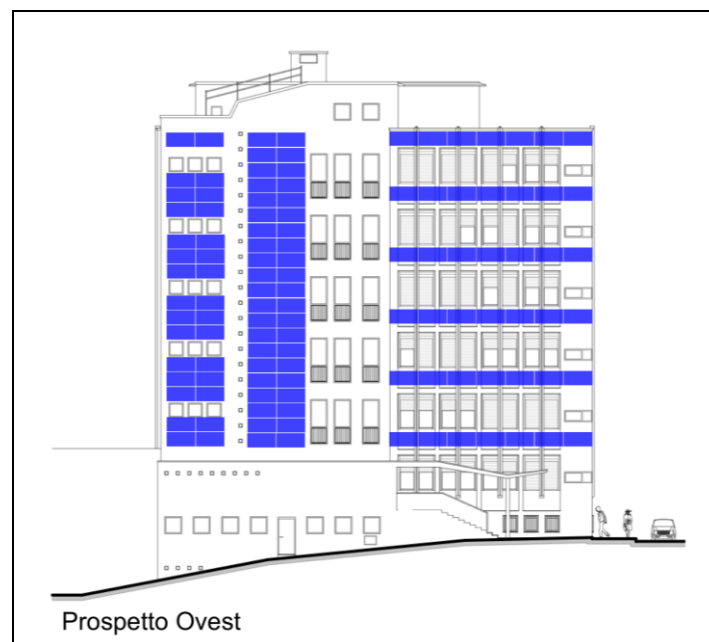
Prospetto Ovest dell'edificio con posizionamento dei moduli PV in facciata.
